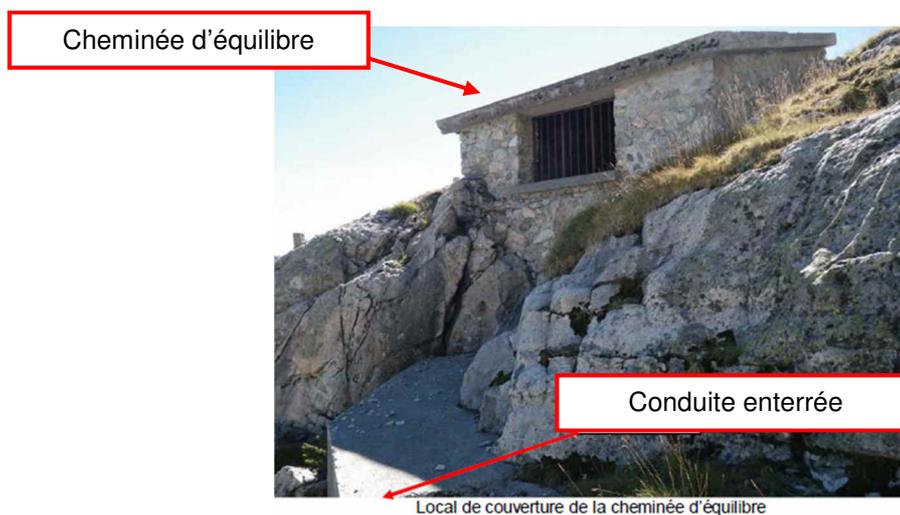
conduite de refoulement et cheminée d'équilibre de Gassiédoat
